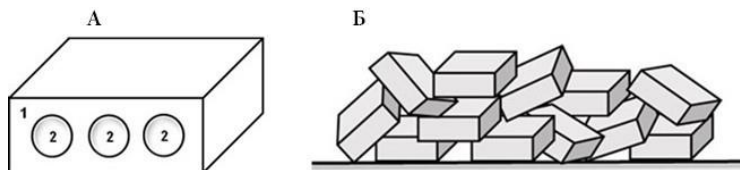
Примеры использования железобетонных модулей для создания тел ИЗУ и ИО: А – отдельный модуль (1 – железобетонная конструкция; 2 – сквозные отверстия). Б – наброска из модулей на основании возводимого тела
